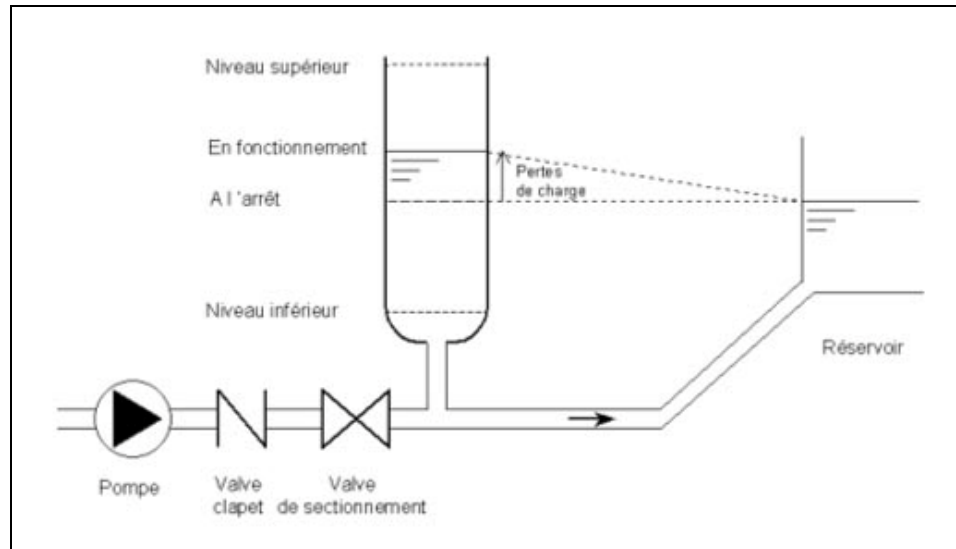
Cheminée d'équilibre sur une conduite de refoulement
